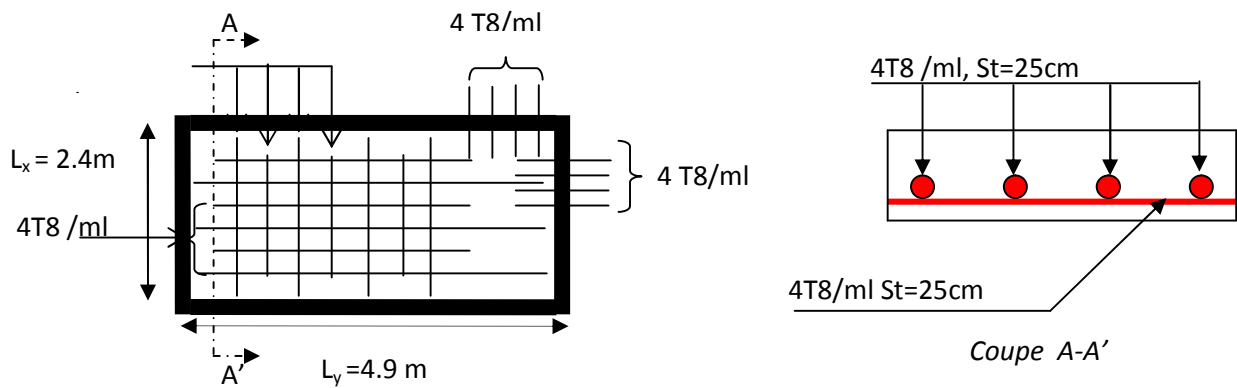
Schéma de ferrailage de la dalle sur 4 appuis panneau 1.
